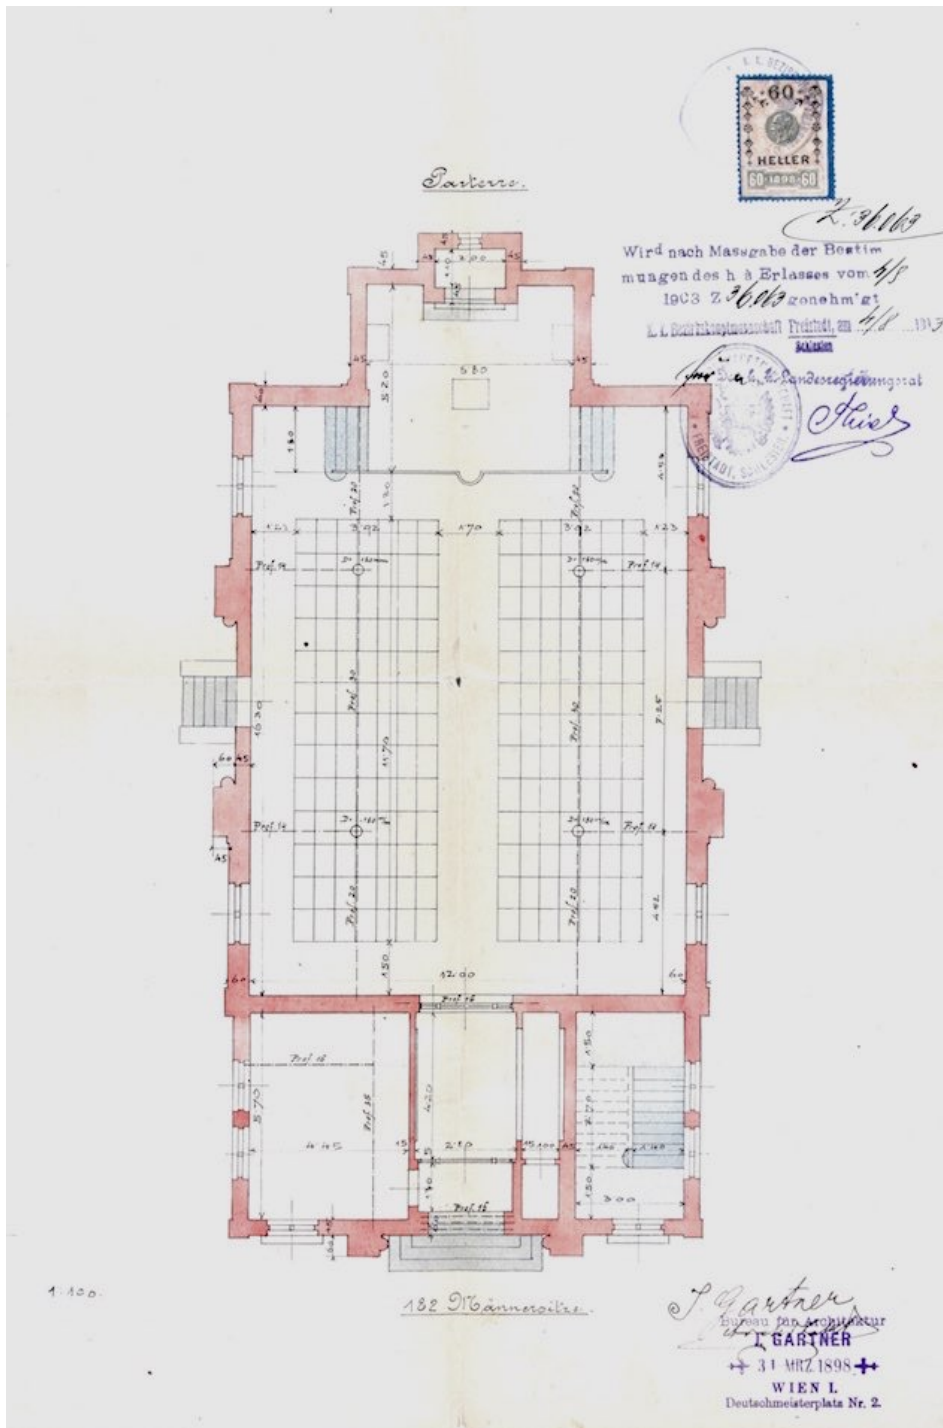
Grundriß Erdgeschoß M 1:100 (linker Teil, beide Grundriße auf einem Plandokument)
